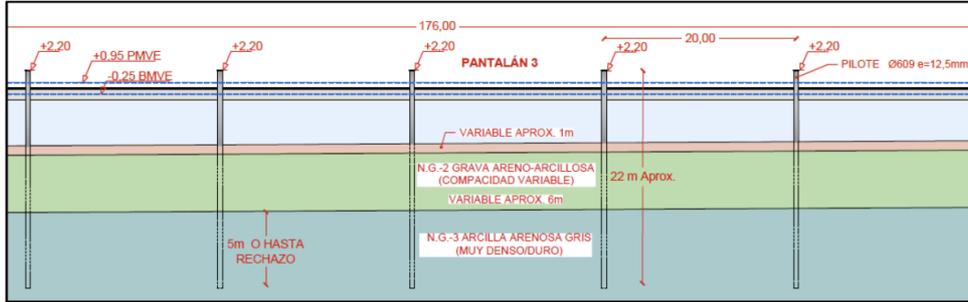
Detalle del perfil geotécnico para la hincada de pilotes
